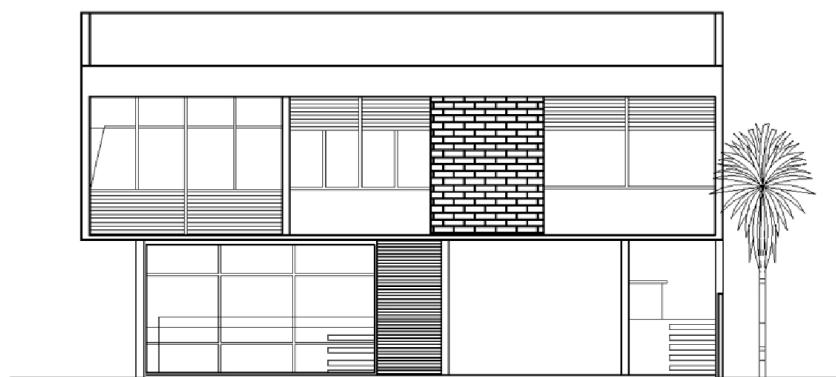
Fachada da Casa Jayme Rendeiro (1963).
